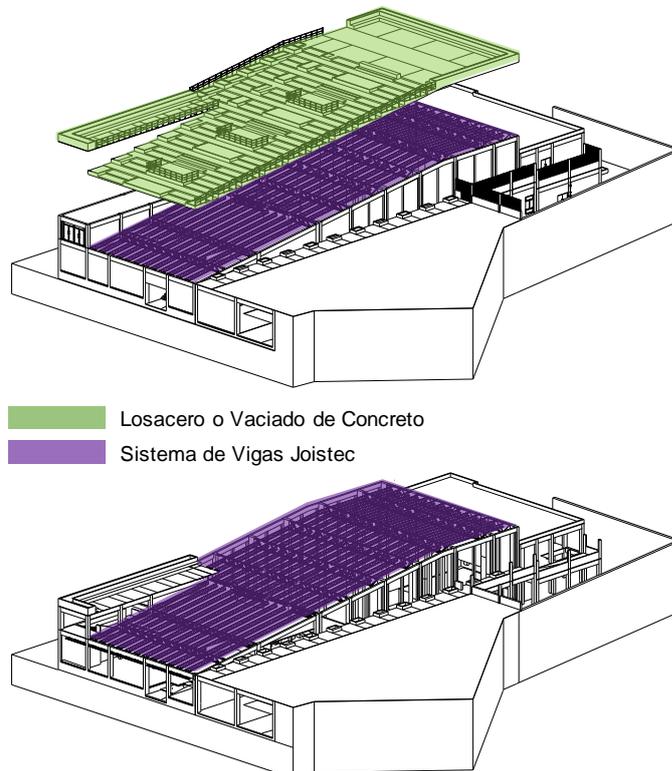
Axonometría de la Superposición de las Vigas Joist y Girder
